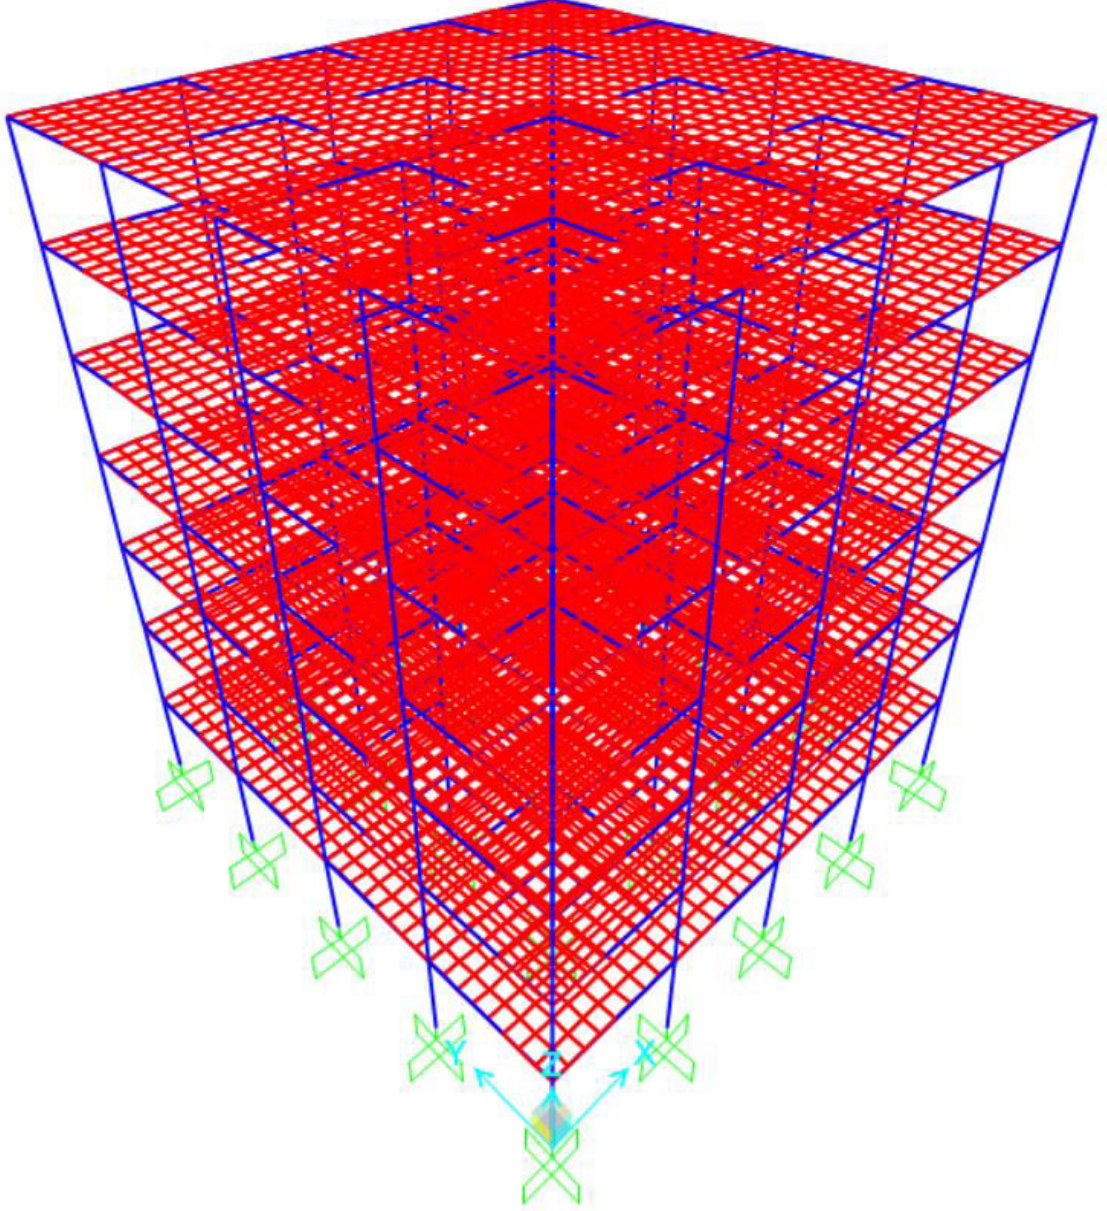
Betonarme taşıyıcı sistemin kat planı
